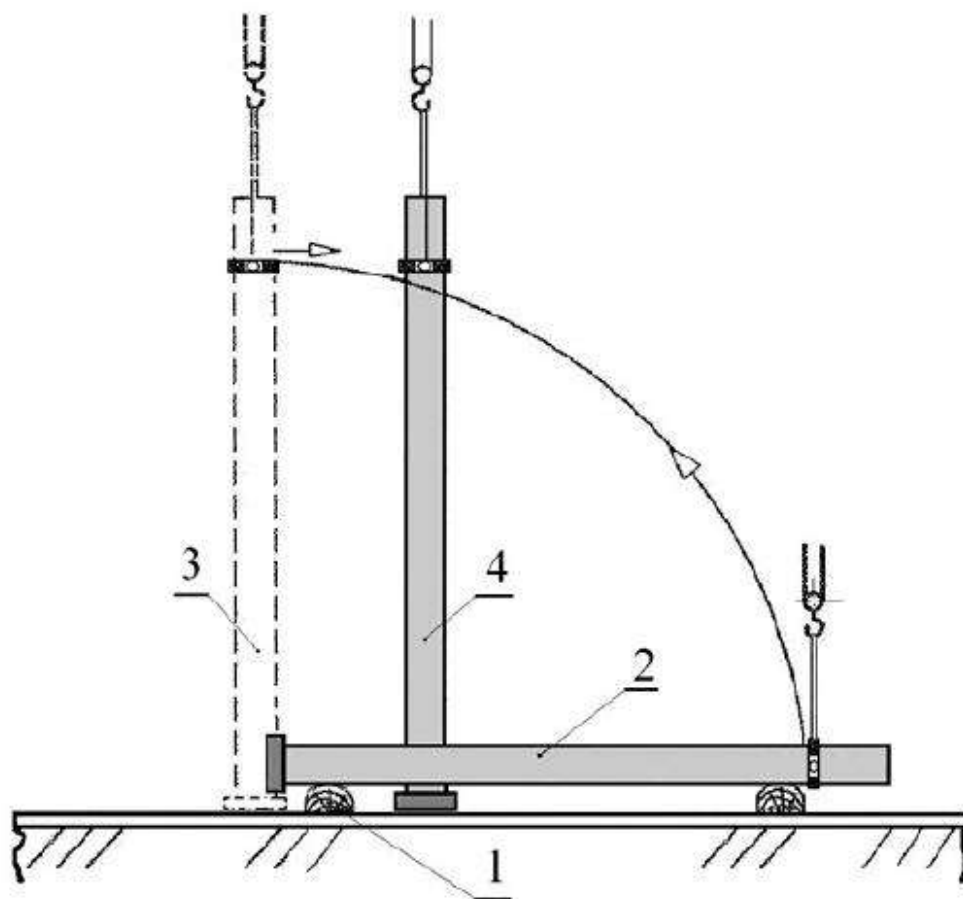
Перед монтажом колонну укладывают на деревянные подкладки (1). Колонну переводят монтажным краном из горизонтального (2) в вертикальное (3), а затем и в проектное положение (4).
